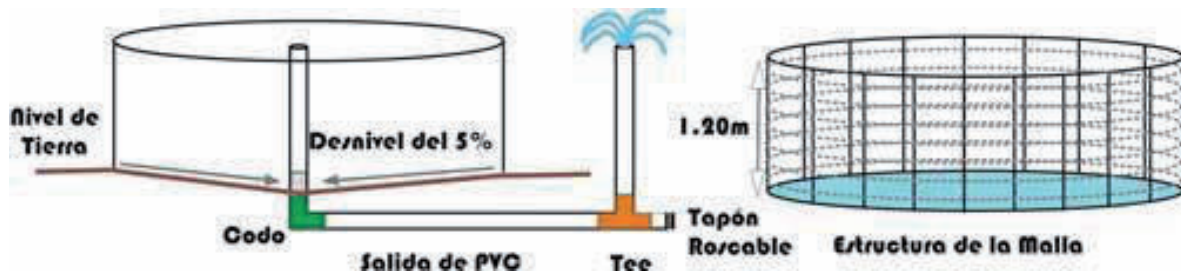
Croquis detallado de la colocación de los estanques de geomembrana dentro del predio.
